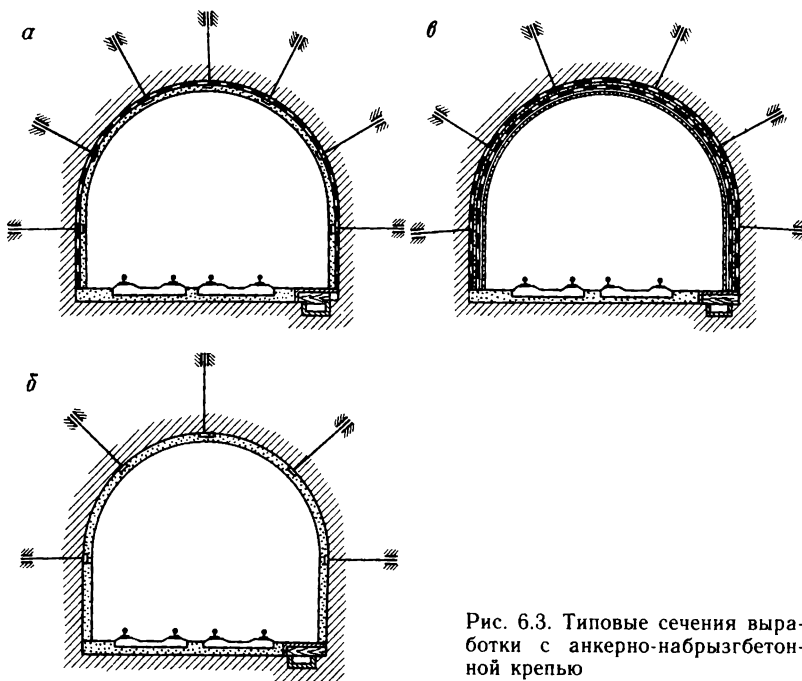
Типовые сечения выработки с анкерно-набрызгбетонной крепью
